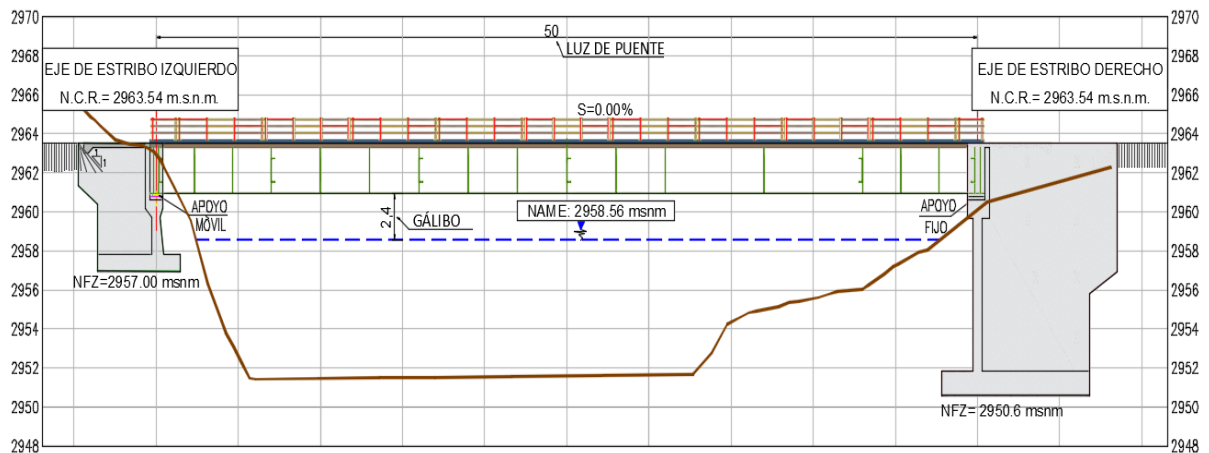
Sección predimensionada del puente proyectado Tingo Chico
